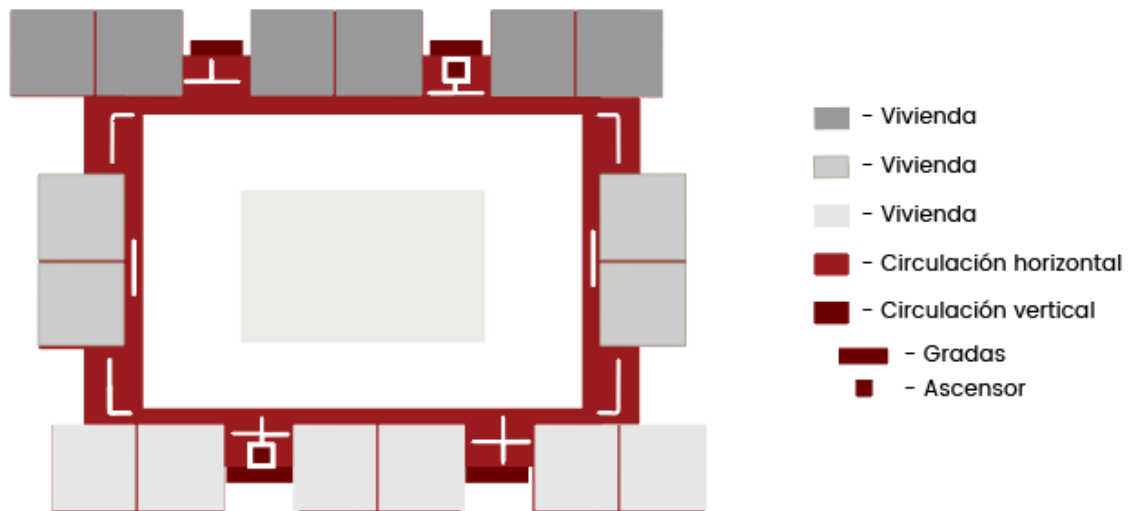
Diagrama Planta Tipo de vivienda. Elaboración propia.
